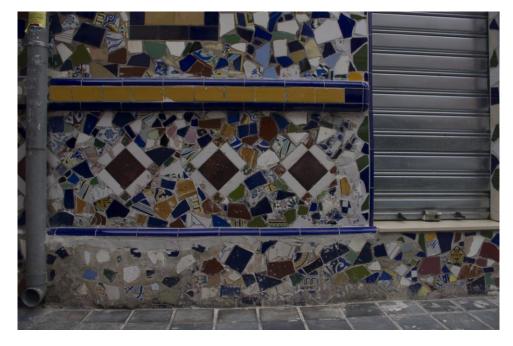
Detalle 'trencadís' en acceso local de planta baja
